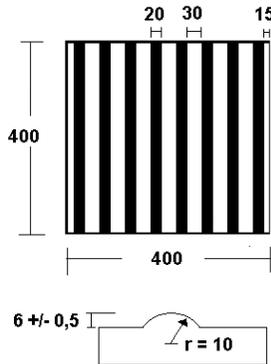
Planta do piso de cautela numa peça de 400mm por 400mm, mostrando as oito barras arredondadas, e o perfil da barra.³⁵
